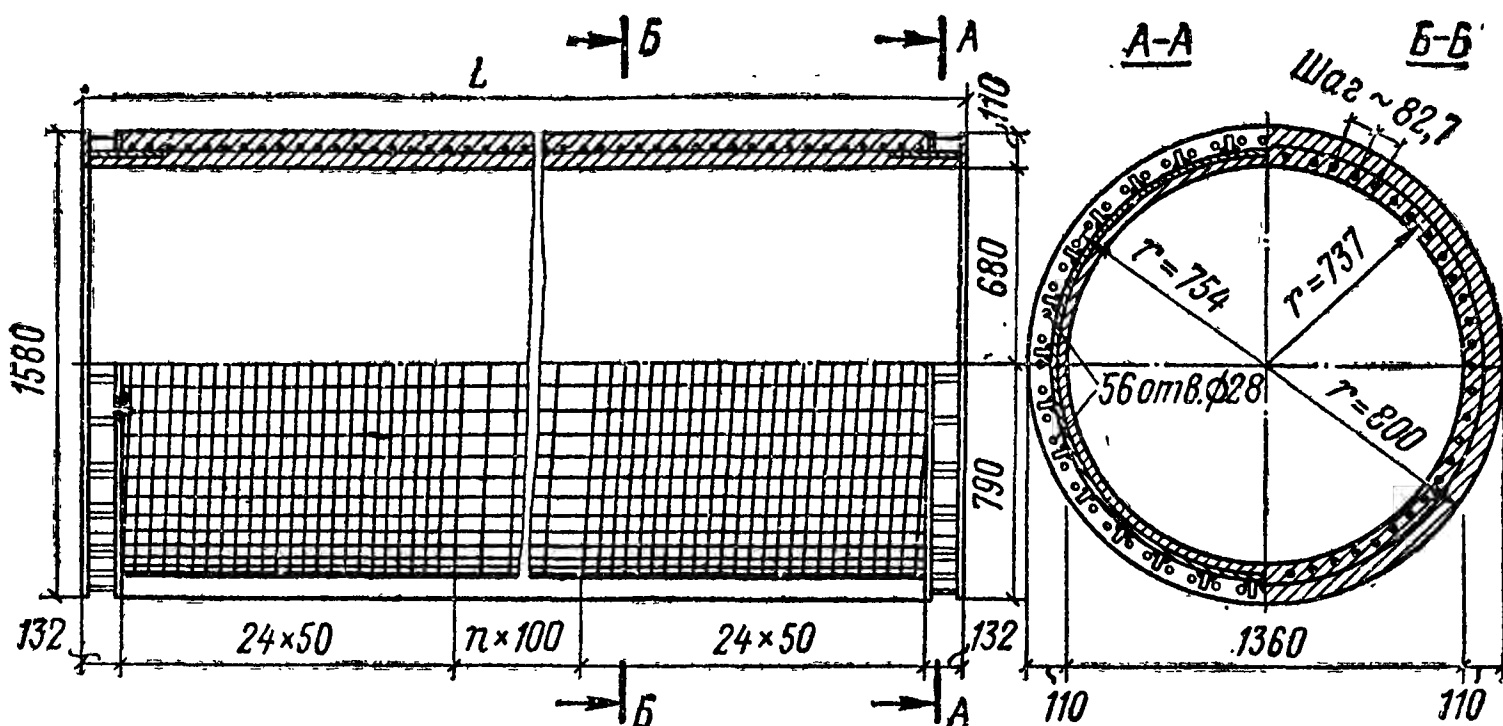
Железобетонная свая-оболочка диаметром 1600 мм с предварительно-напряженной арматурой
